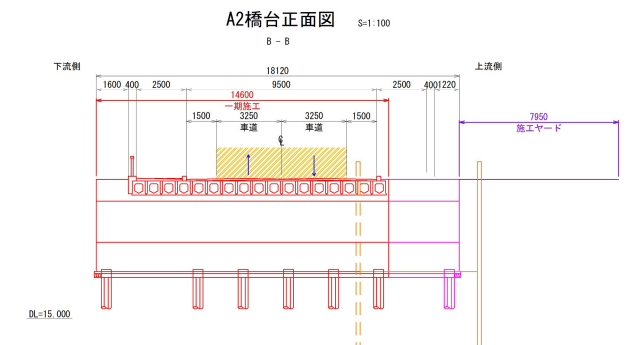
施工ステップ正面図（下部工構築 A2 橋台時）
